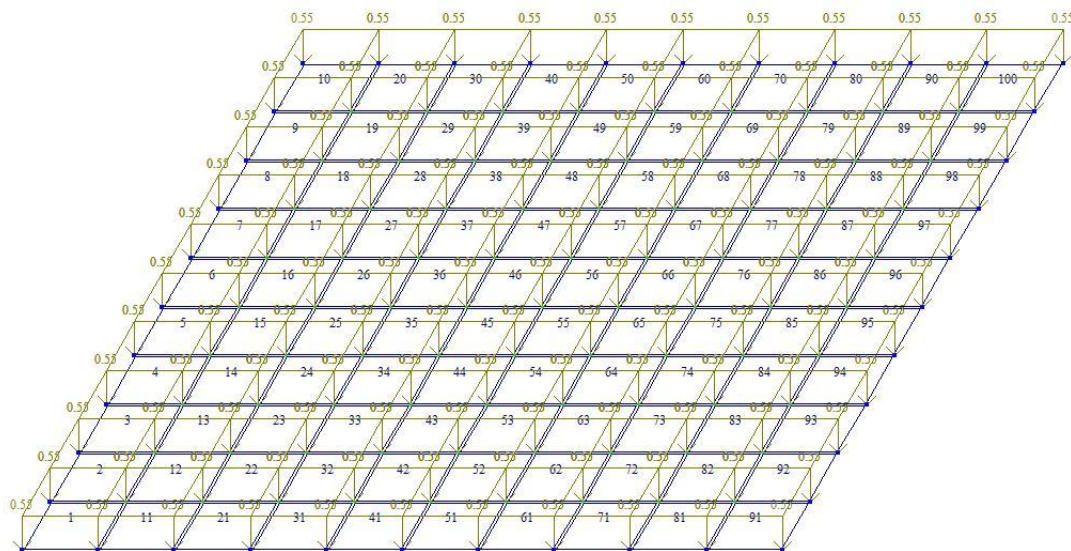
Нагрузка на плиту перекрытия лифтовой шахты от собственного веса плиты перекрытия.
